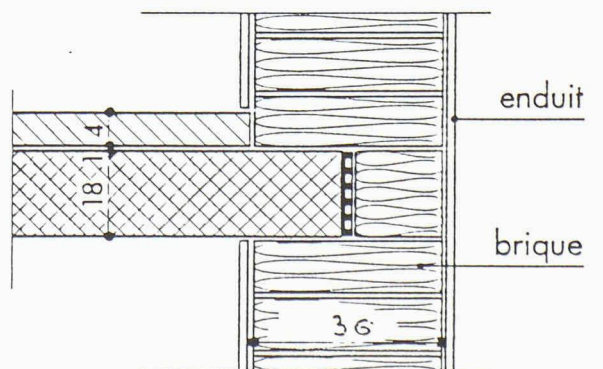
Coupe verticale d'un mur avec isolation répartie sur l'épaisseur
